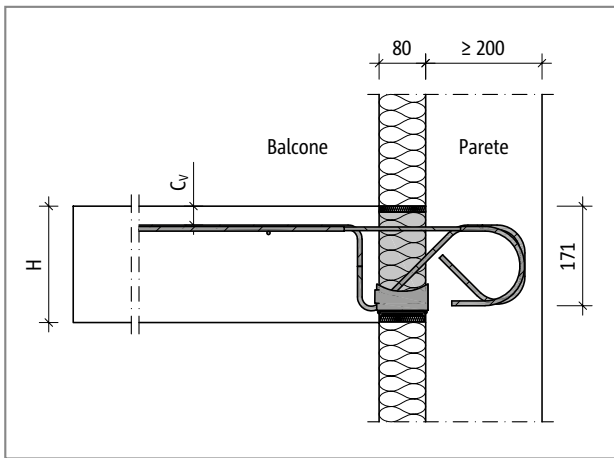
Schöck Isokorb® T tipo KL-O-M1 – KL-O-M7: raccordo alla parete con isolamento esterno
